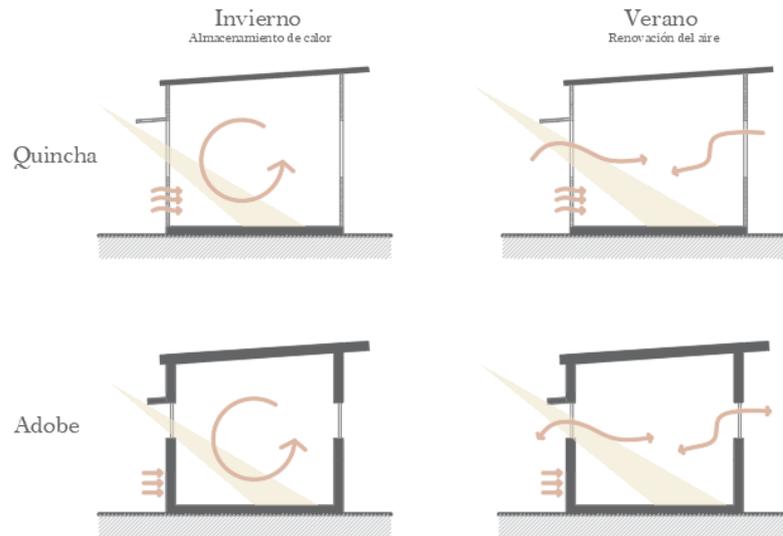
Estrategias de aislamiento térmico. Fuente: Propia
